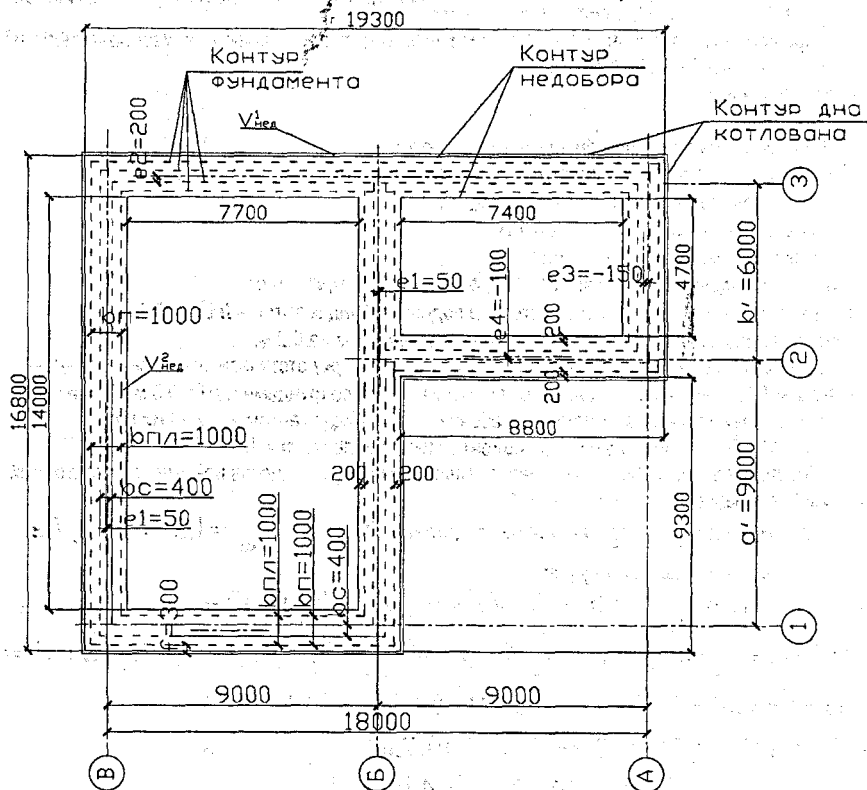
Схема к определению объема грунта недобора котлована сложной формы для фундаментов, представленных на рис.4.4.5
